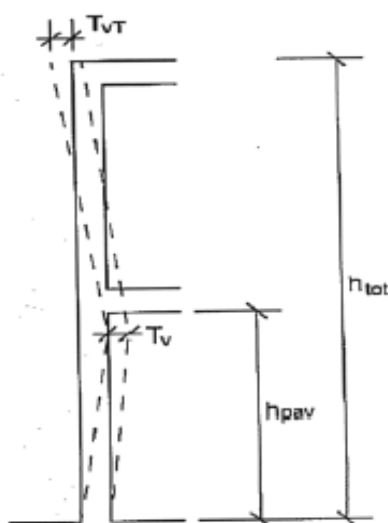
Tolerâncias para desalinhamento horizontal das paredes
